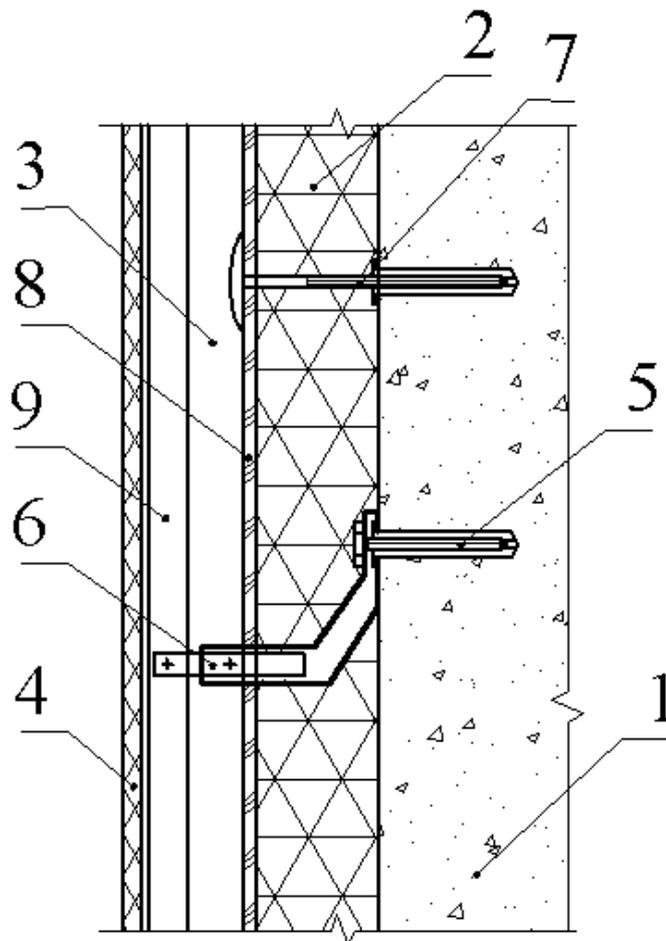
Схема наружной стены с теплоизоляцией и отстоящим фасадным экраном (вентилируемый фасад):
